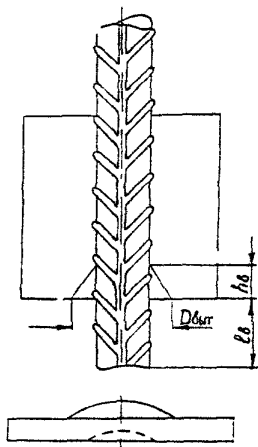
Схема установочных размеров анкерного стержня перед сваркой
